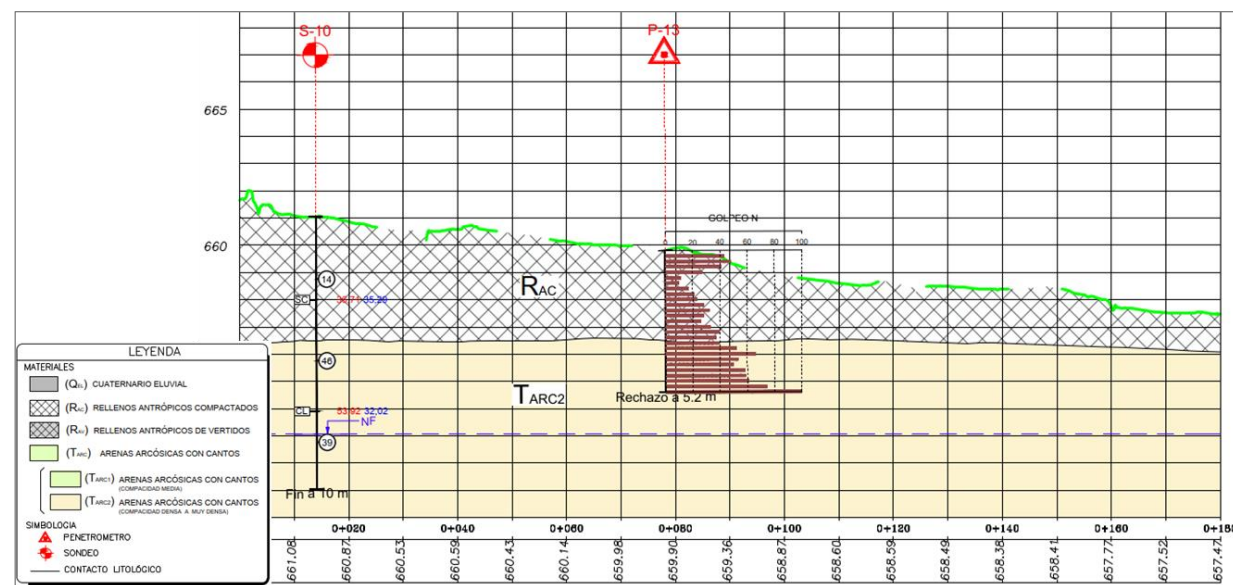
Perfil longitudinal Pantalla A1-16-MD-1(1)
